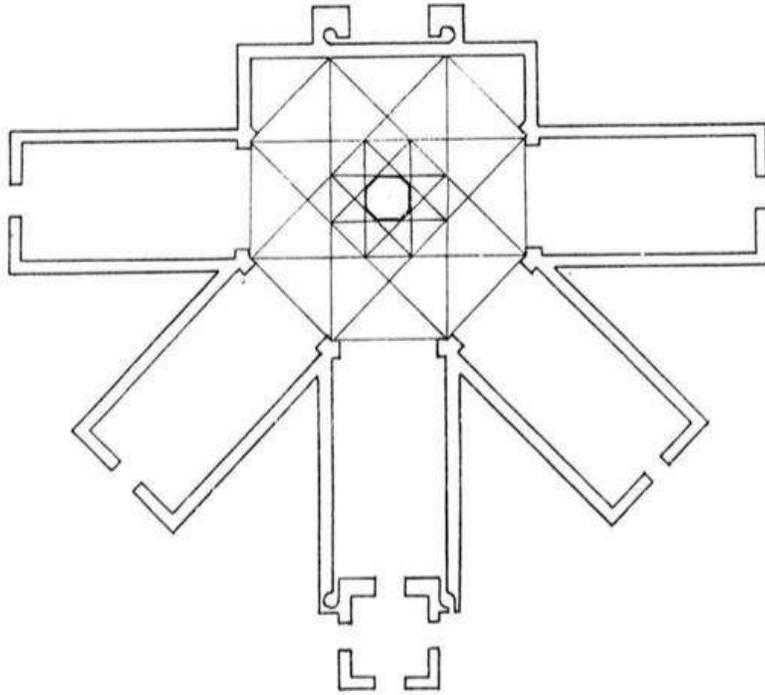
Reconstrucción de la planta de la basílica de Pátzcuaro.
